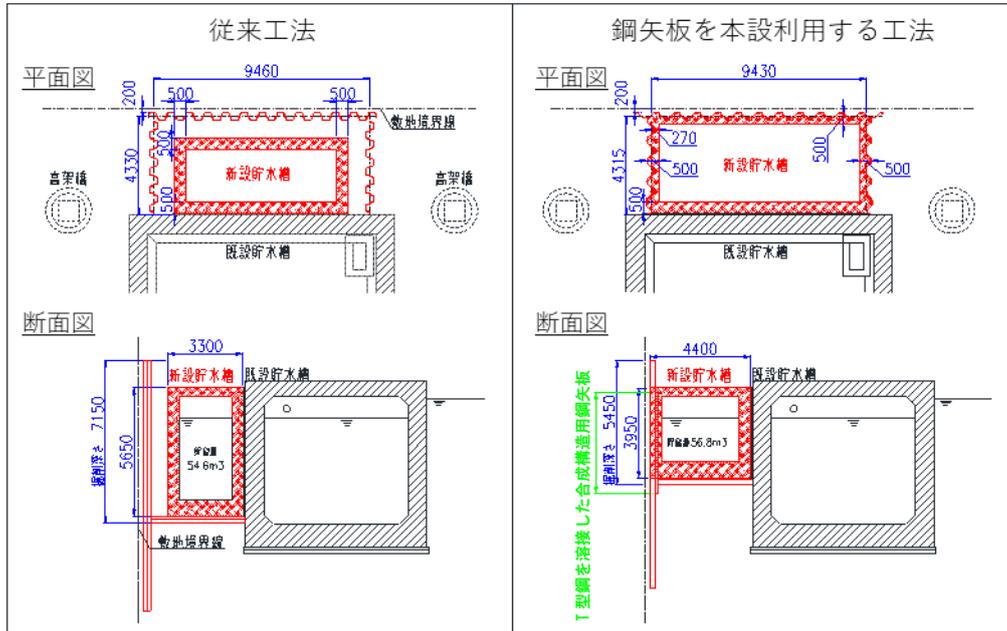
従来工法と鋼矢板を本設利用する工法の平面図・断面図の比較
